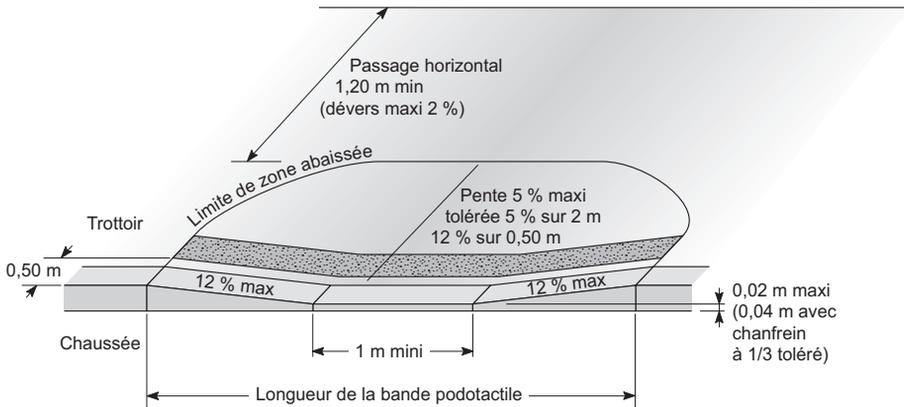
Abaissement de trottoir au niveau de la chaussée (source : P 98-350).
